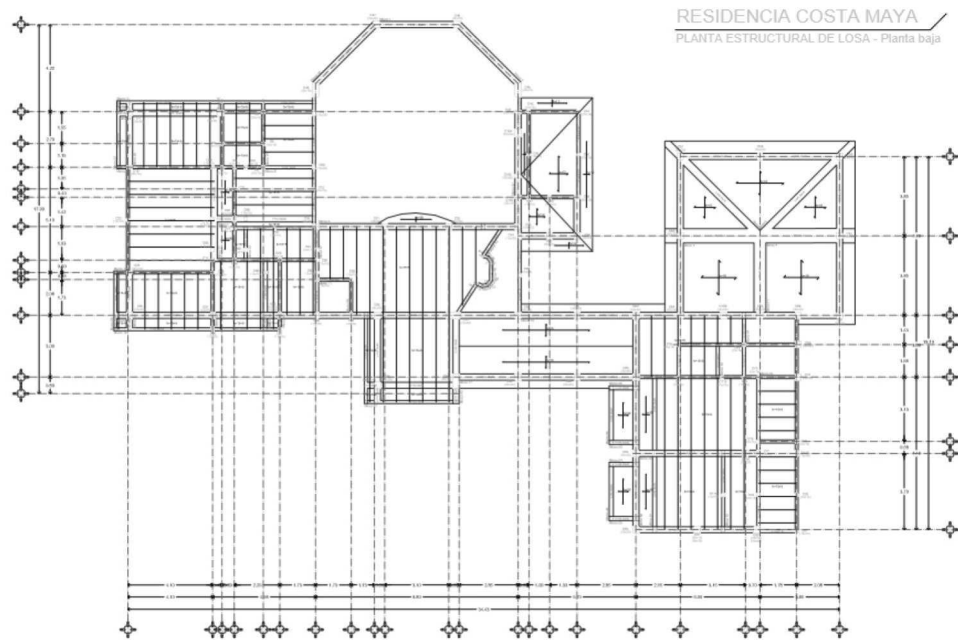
Plantas estructurales de losa planta baja, con sus respectivas trabes y cadenas.
